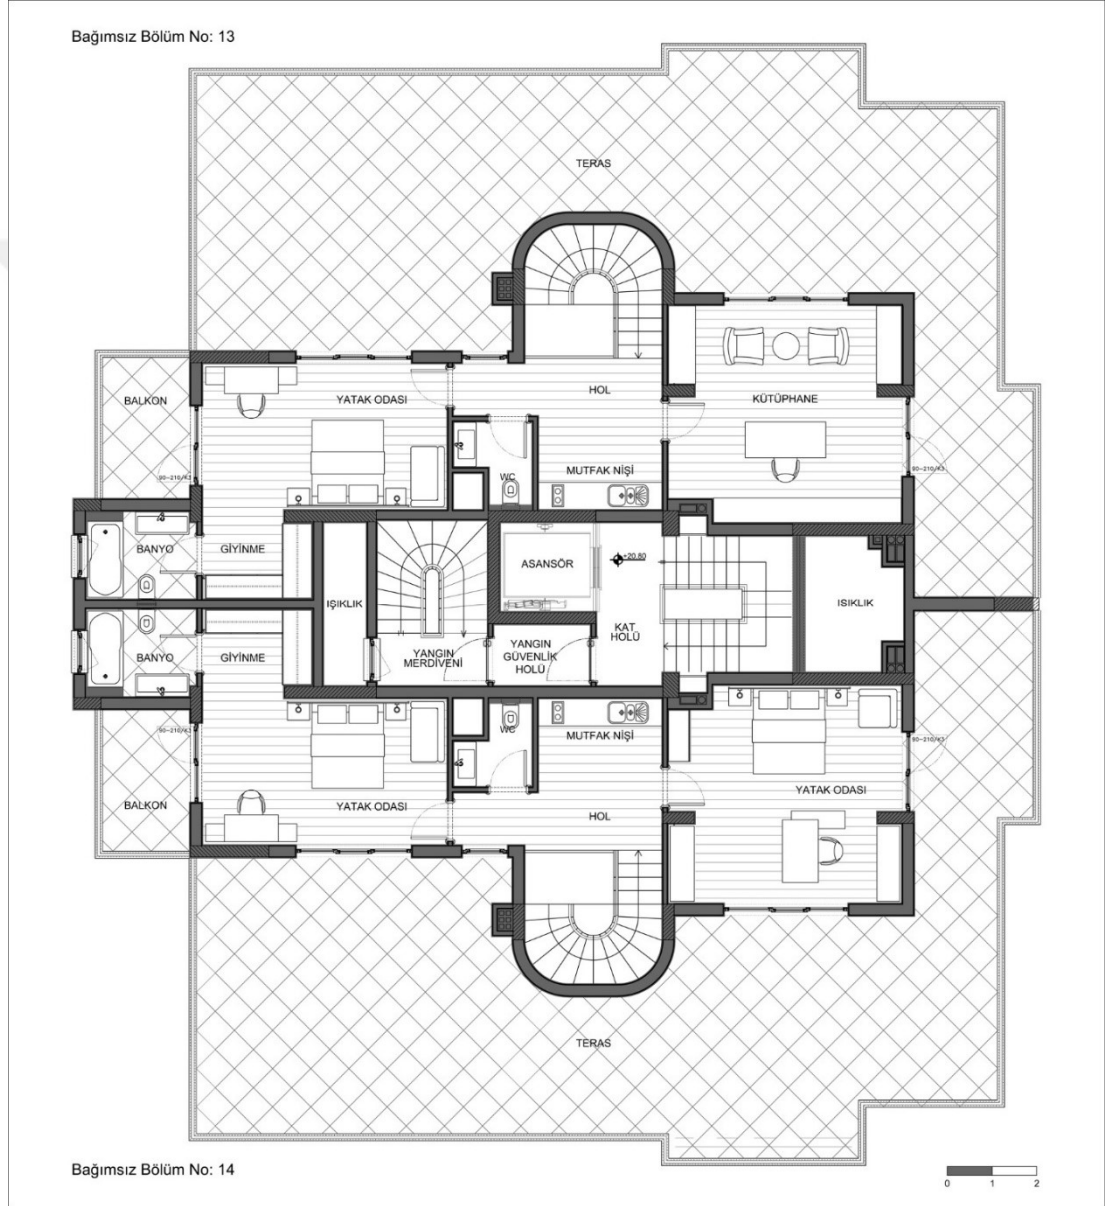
19. 7. Kat: Bağımsız Bölüm No:13-14 Giriş Kat Yerleşim Planı
